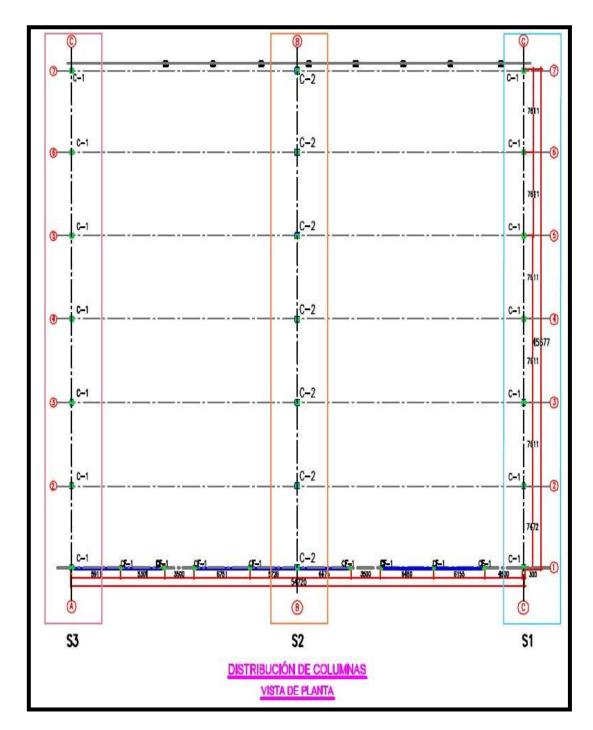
Elementos Verticales – Columnas. (Fuente: Servimetales S.A.C.)
